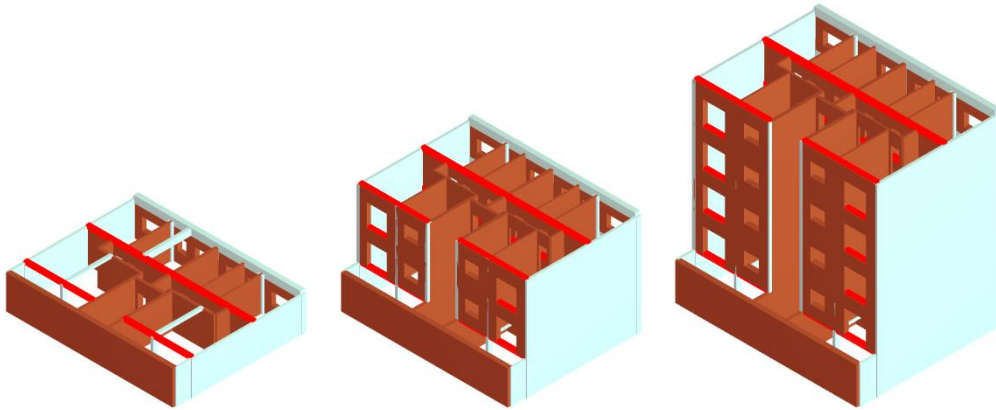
Esquema de introdução da viga de contraventamento ao nível do pavimento em cada piso em uma parede interior segundo a direção (X), e do reforço das vigas da fachada principal com fibra de carbono, rés-do-chão (esq.), 2º piso (meio) e cobertura (dirt.).
